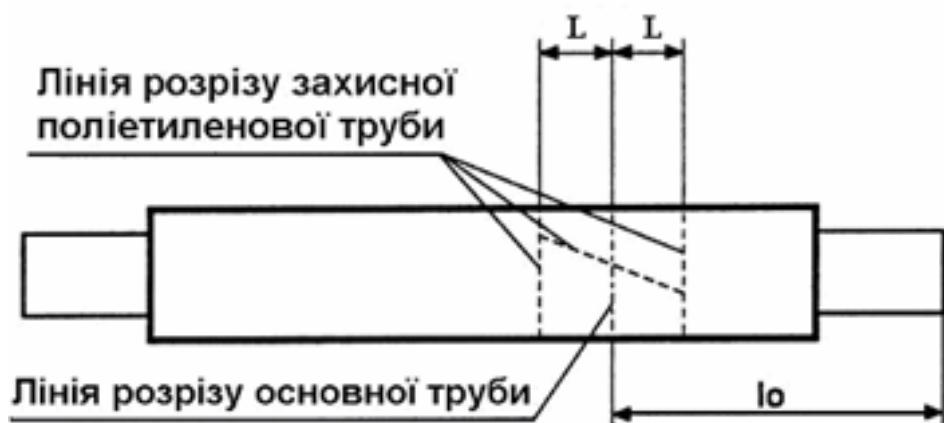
Підготовка до розрізання попередньоізольованої труbi
